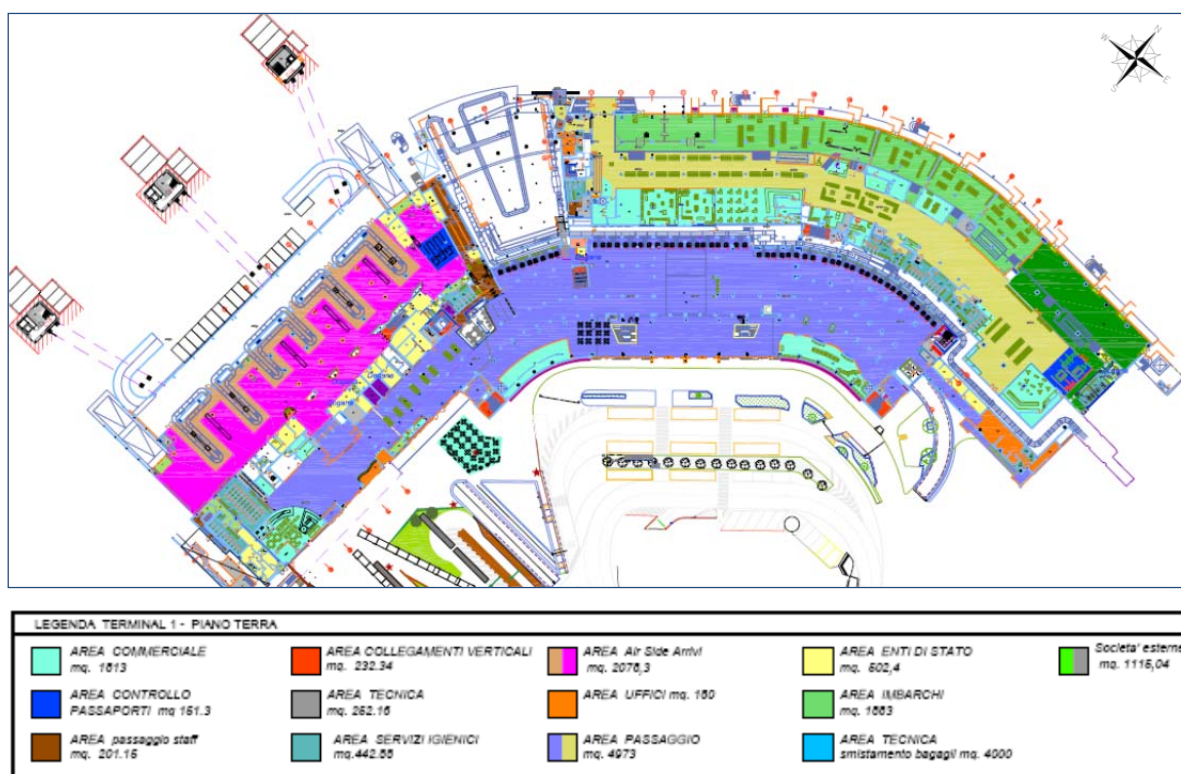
Terminal 1 – Pianta piano terra – Primo livello funzionale
